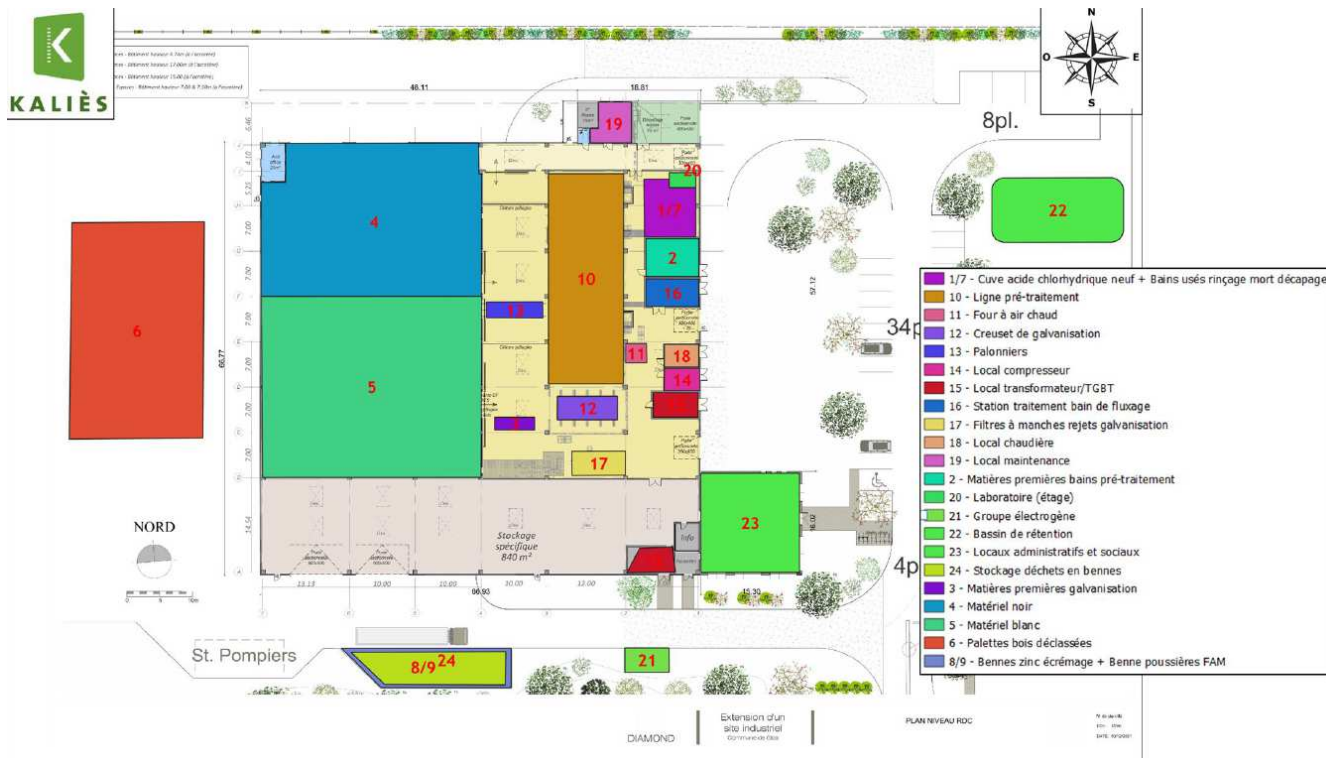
Plan des installations nécessaires à la réalisation du projet (source : p. 18 du fichier "Description du projet")
